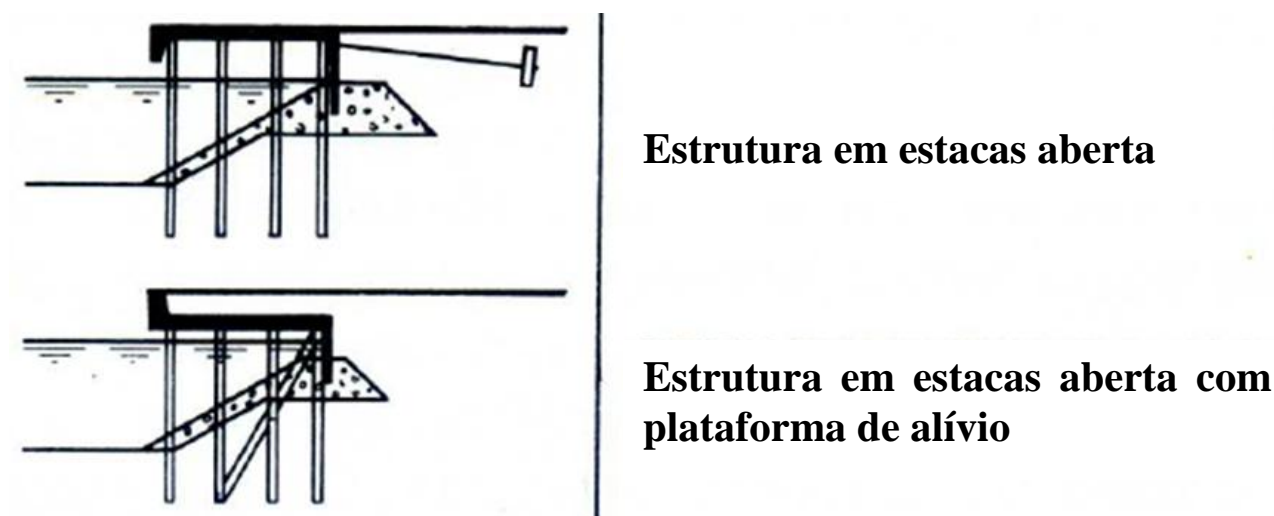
Exemplos de estruturas em pilares (retirado de Berth and terminal design)
